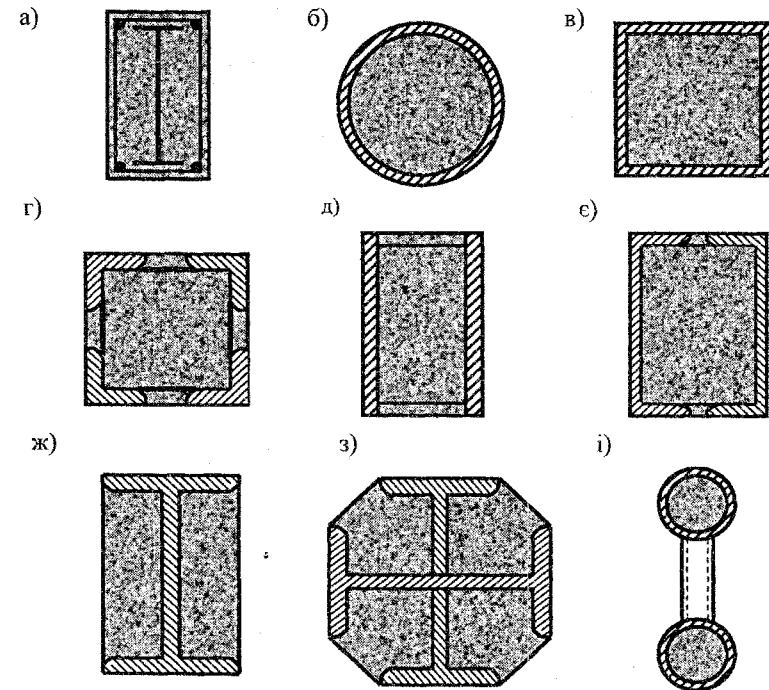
Поперечні перерізи сталезалізобетонних колон:
